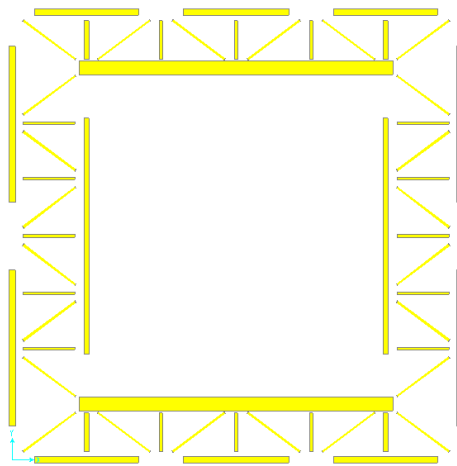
Parrilla piso 2 Acero - Ceniza
